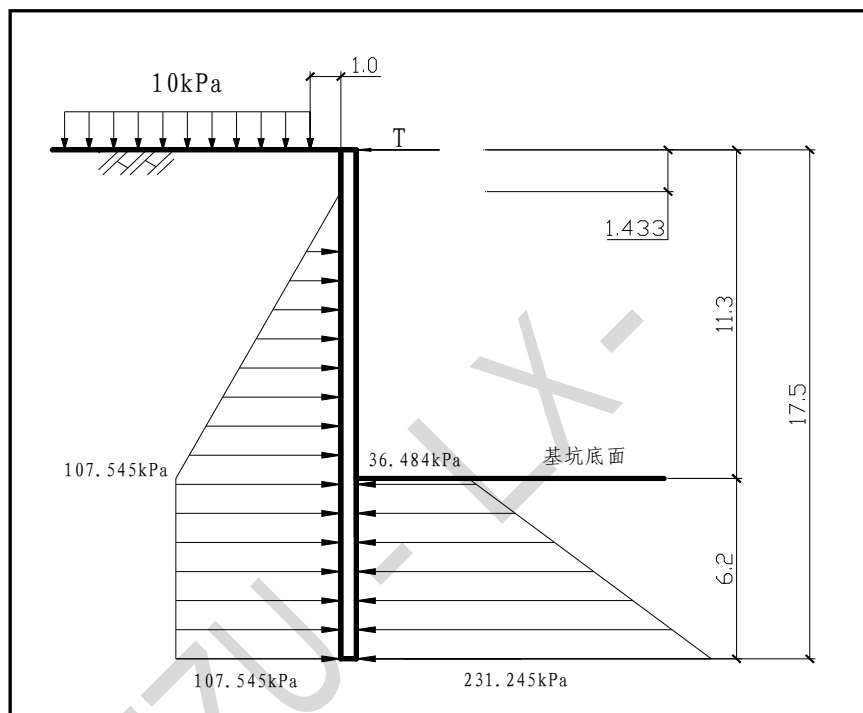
开挖至 11.3m 的力学计算简图（尺寸单位：m）
